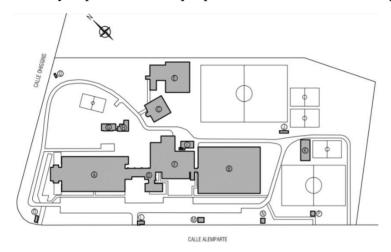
Plano de Emplazamiento (Toro Silva, 2018).
